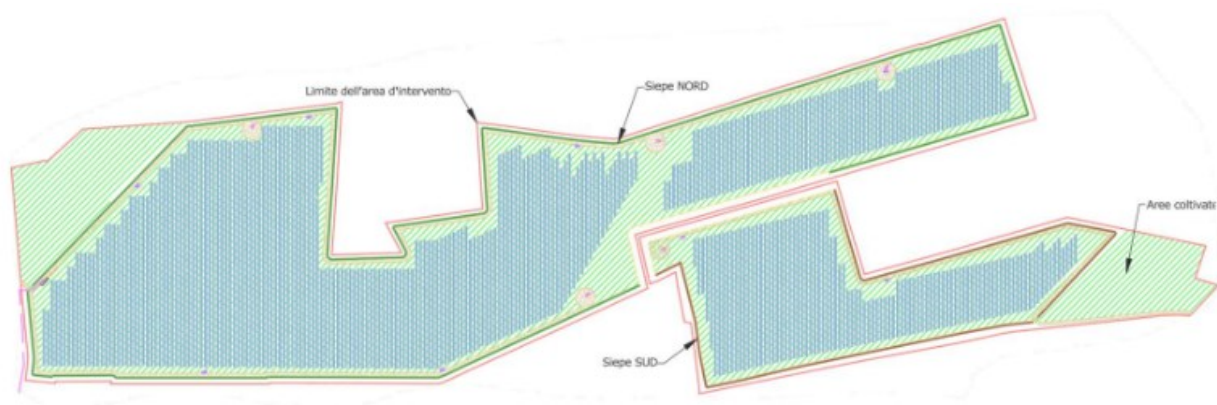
Planimetria generale con andamento delle siepi perimetrali
